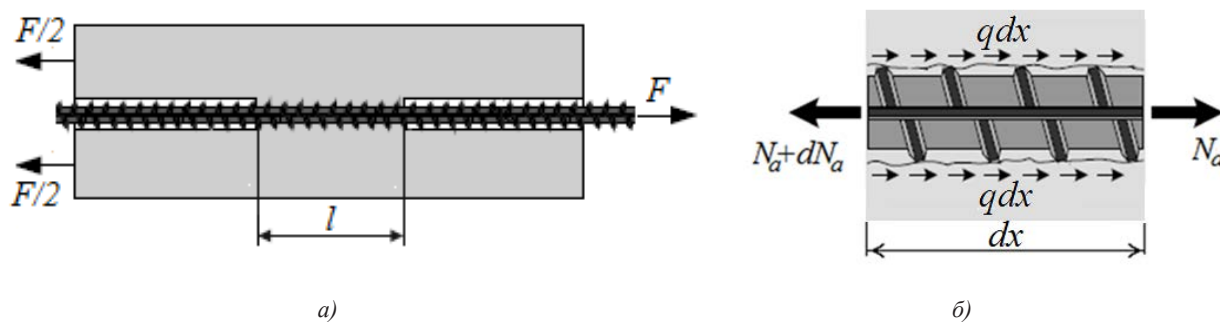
Схема взаємодії арматурного стержня з бетоном
